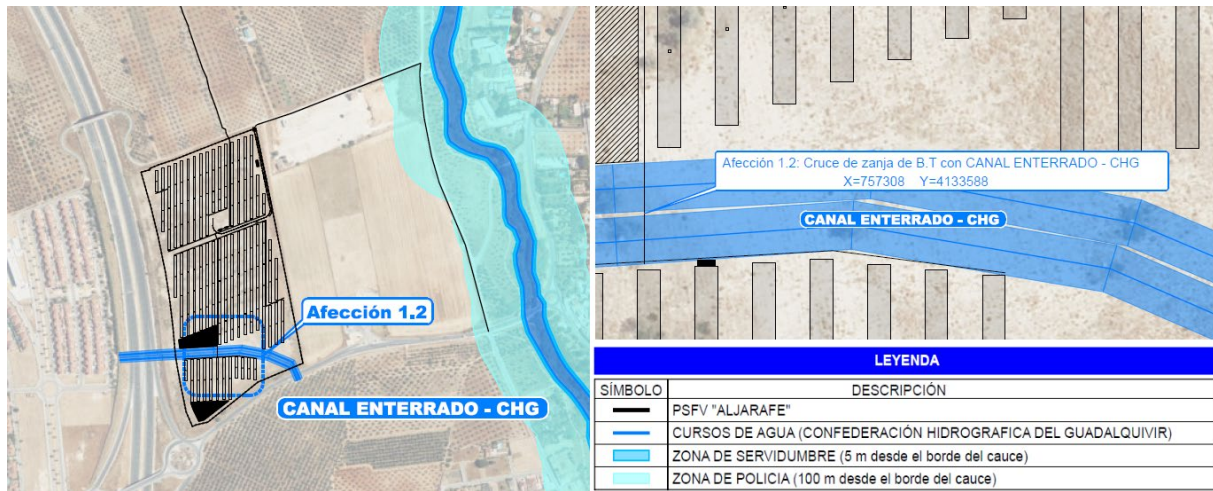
Cruce de zanja de B.T con canal enterrado - CHG.
